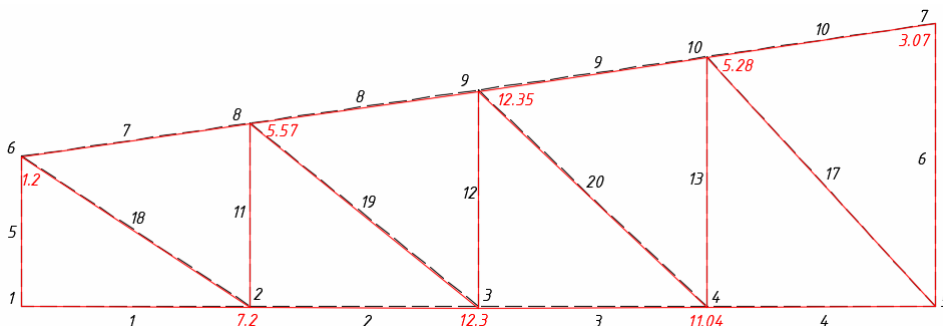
Перемещения узлов фермы, мм, вариант №4
